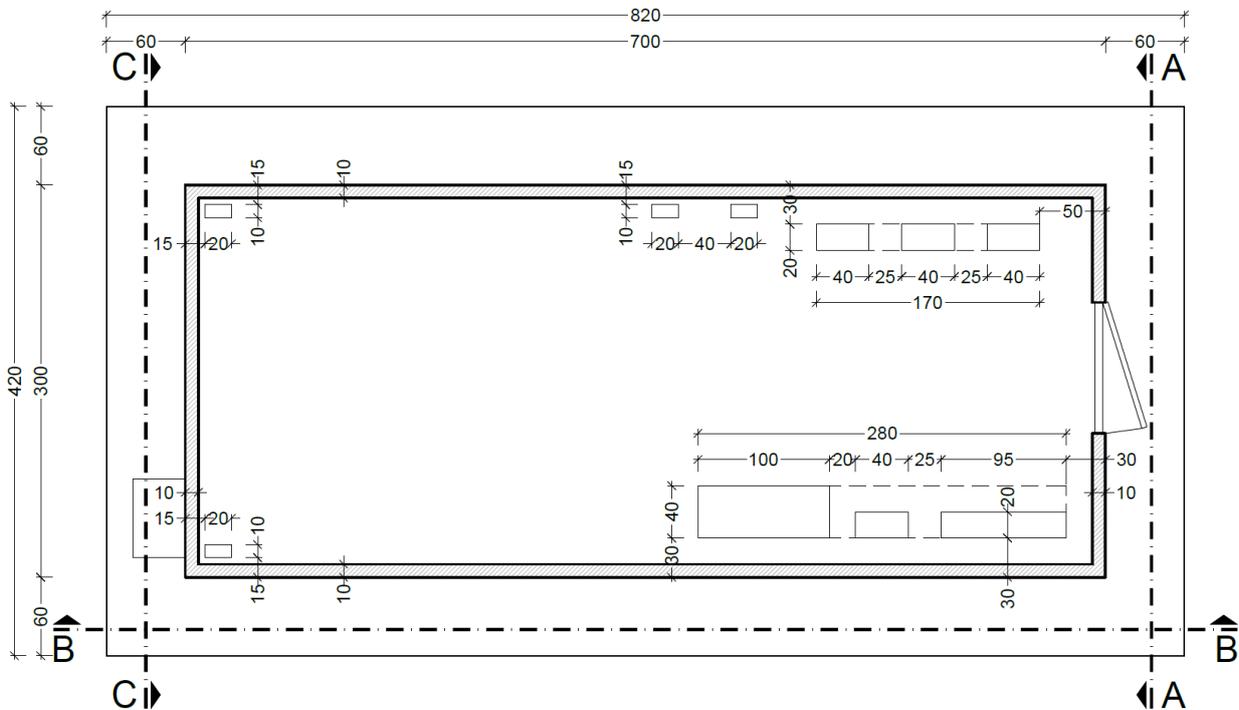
Pianta tipo basamento fondazione PPT con indicazione forometrie
